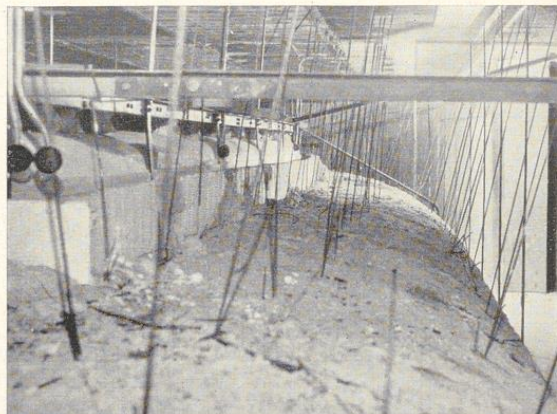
Abhängung einer großen Gewölbenvoute (Schillertheater, Berlin)
